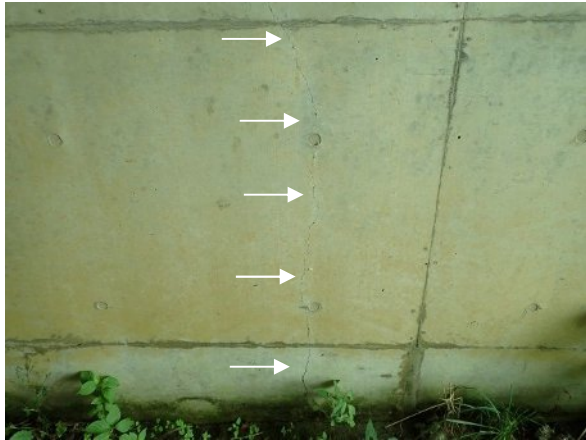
外部拘束による温度ひび割れ
